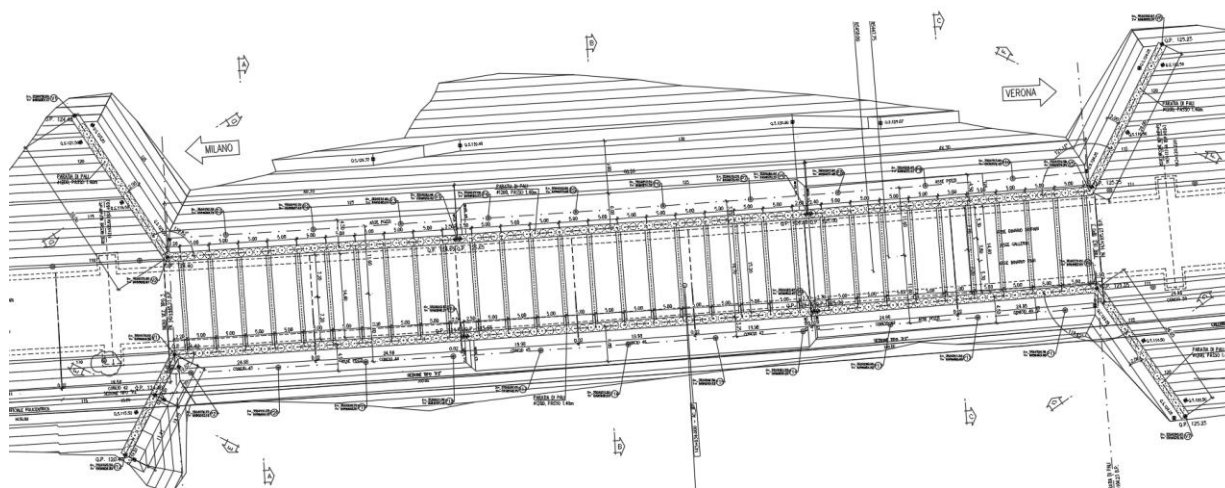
Planimetria della doppia paratia di pali contrapposti.
